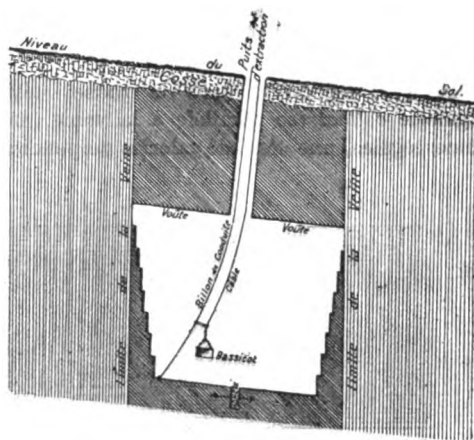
Coupe verticale d'un fond en descendant sous voûte.
